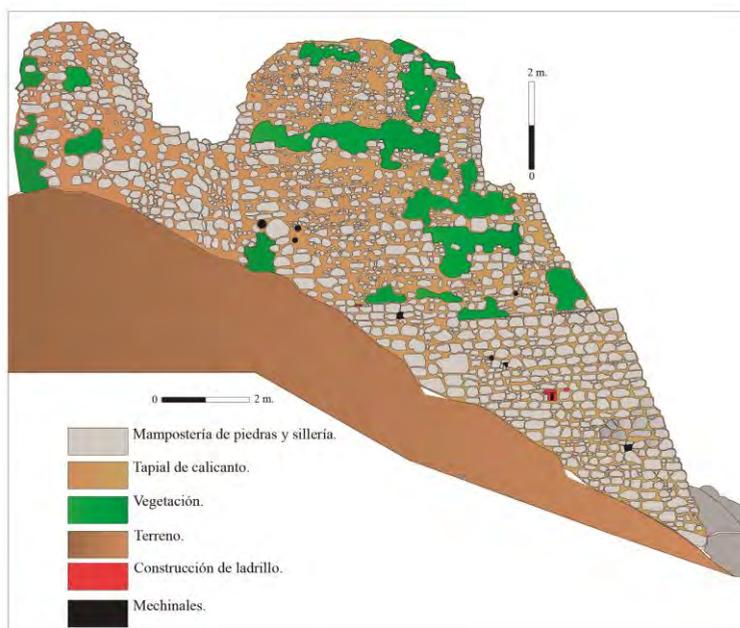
Alzado noroeste exterior de la puerta de la fortaleza.
